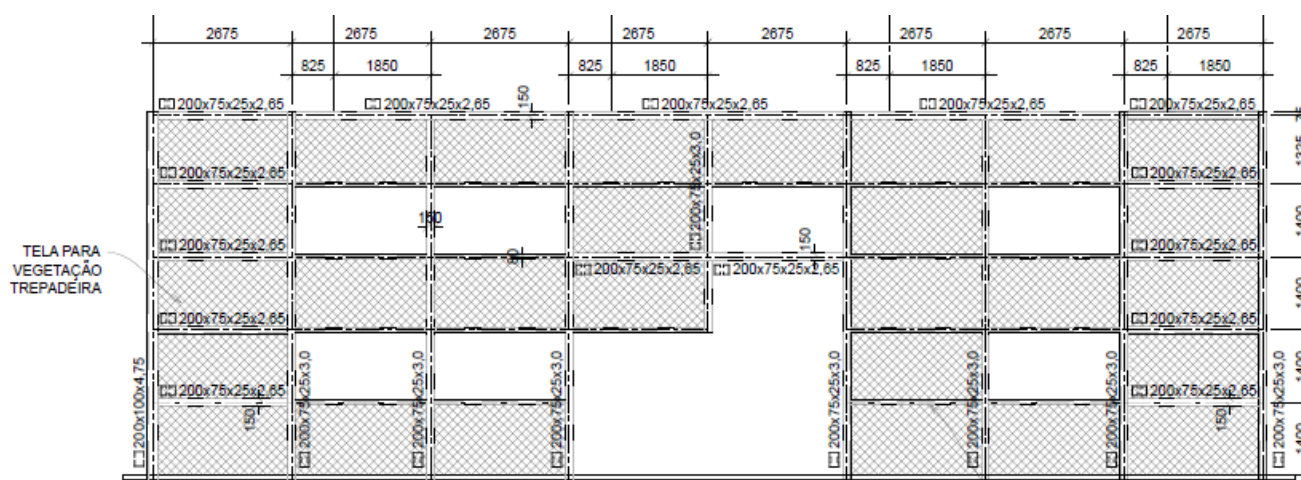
Elevação de uma das laterais da fachada – Galpão UDR
